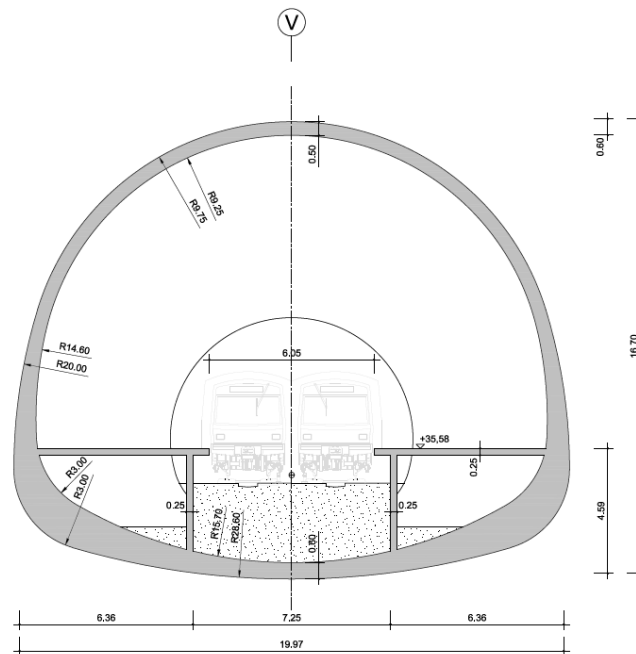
Secção transversal corrente do Túnel do Cais
